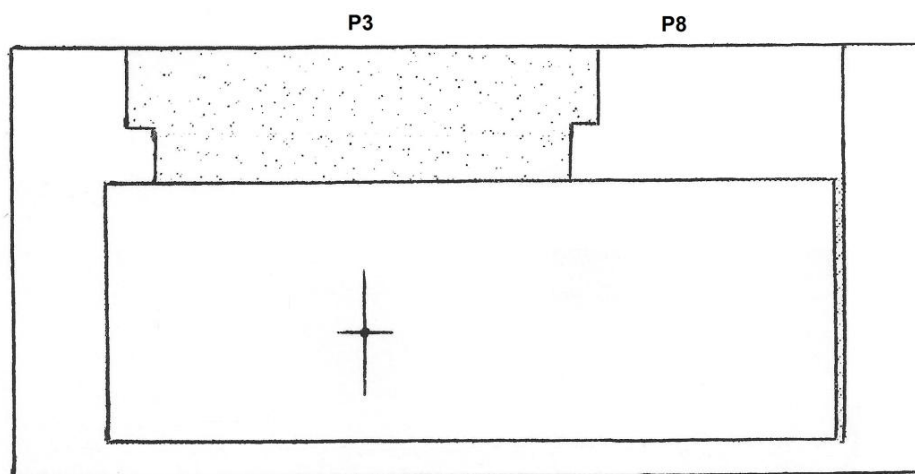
Planta da instalação de radioterapia externa em corte vertical e identificação dos pontos de medição.
